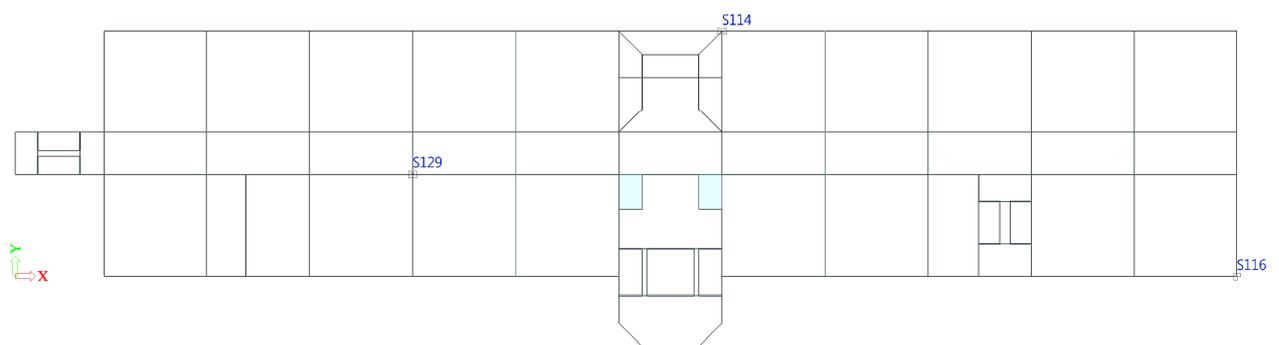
Grundriss Erdgeschoß - Position der maßgebenden Stützen
